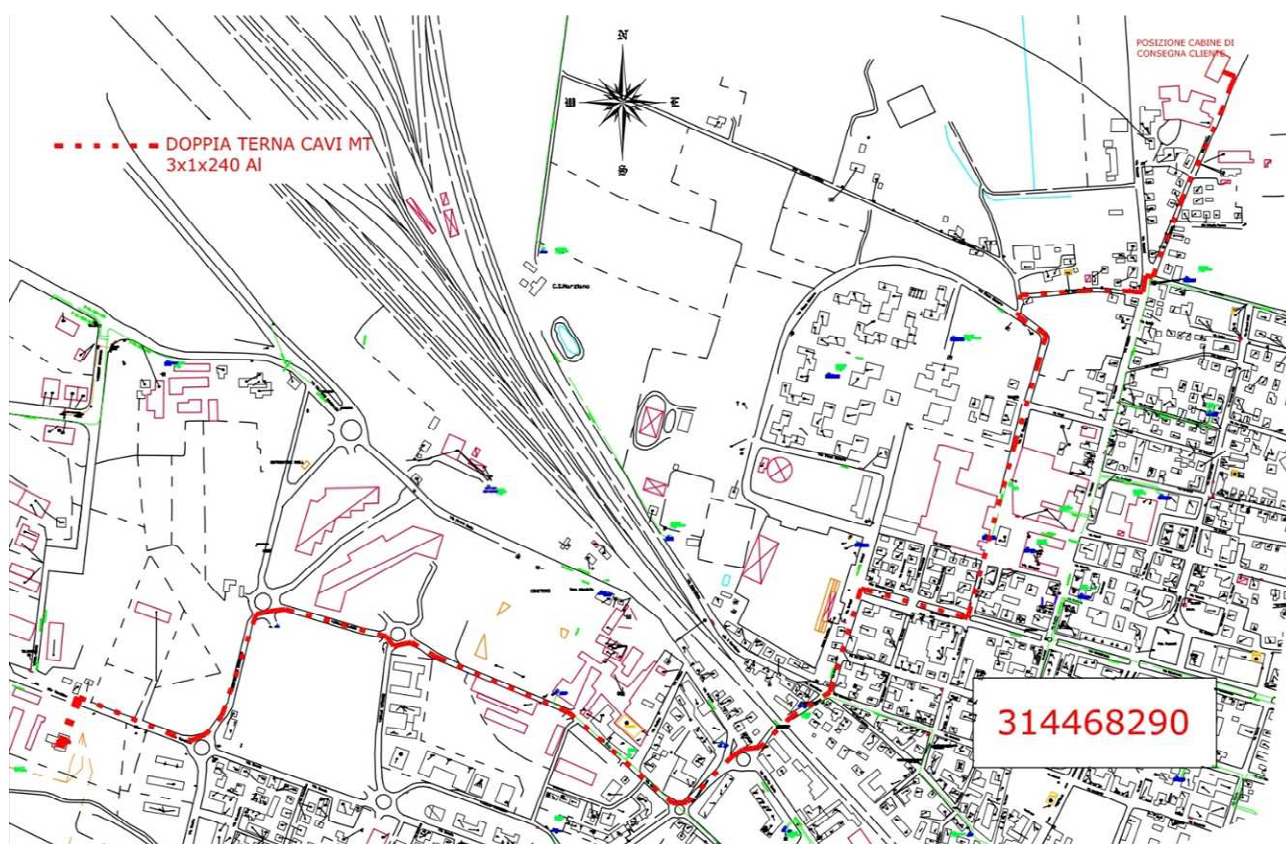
Planimetria STMG riportante il tracciato di massima dell'impianto di rete per la connessione
